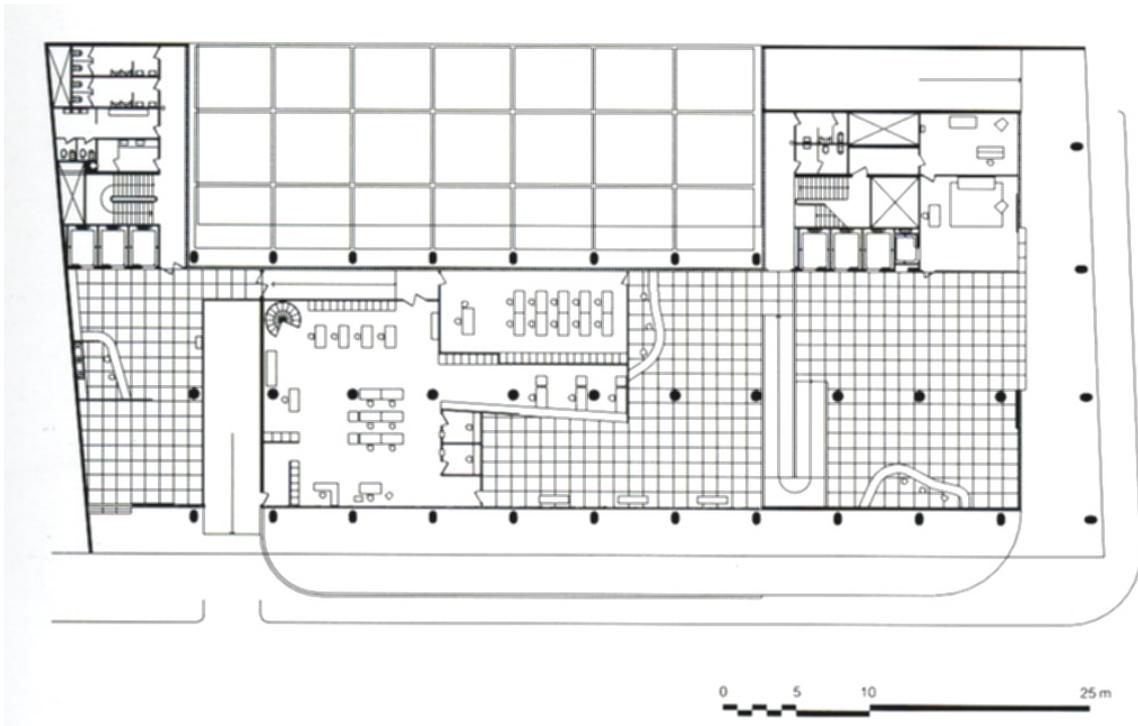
Planta térreo do edifício: fachadas acompanham o alinhamento das construções da mesma rua, edifício sobre pilotis, circulação vertical bi-nuclear.
